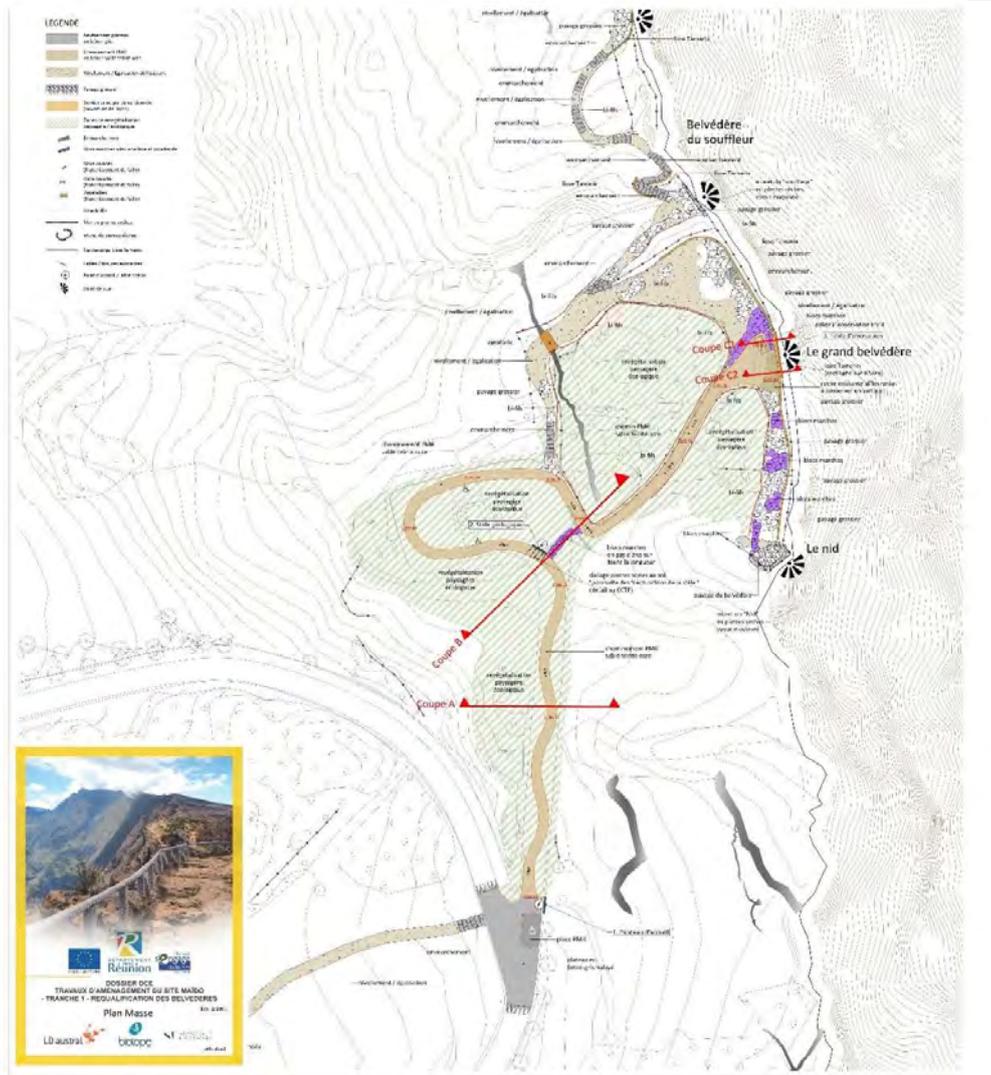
plan masse du projet – Zoom sur les belvédères (DCE – ©LD Austral, 2023)
